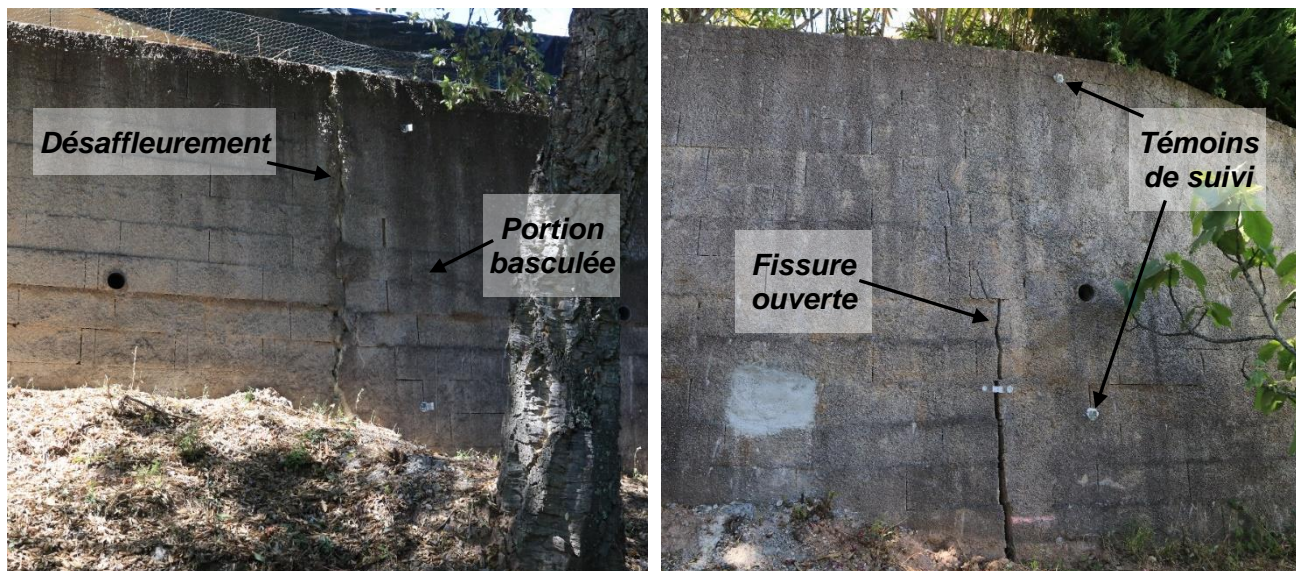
Mur de soutènement basculé (à gauche) et fissuré (à droite)
